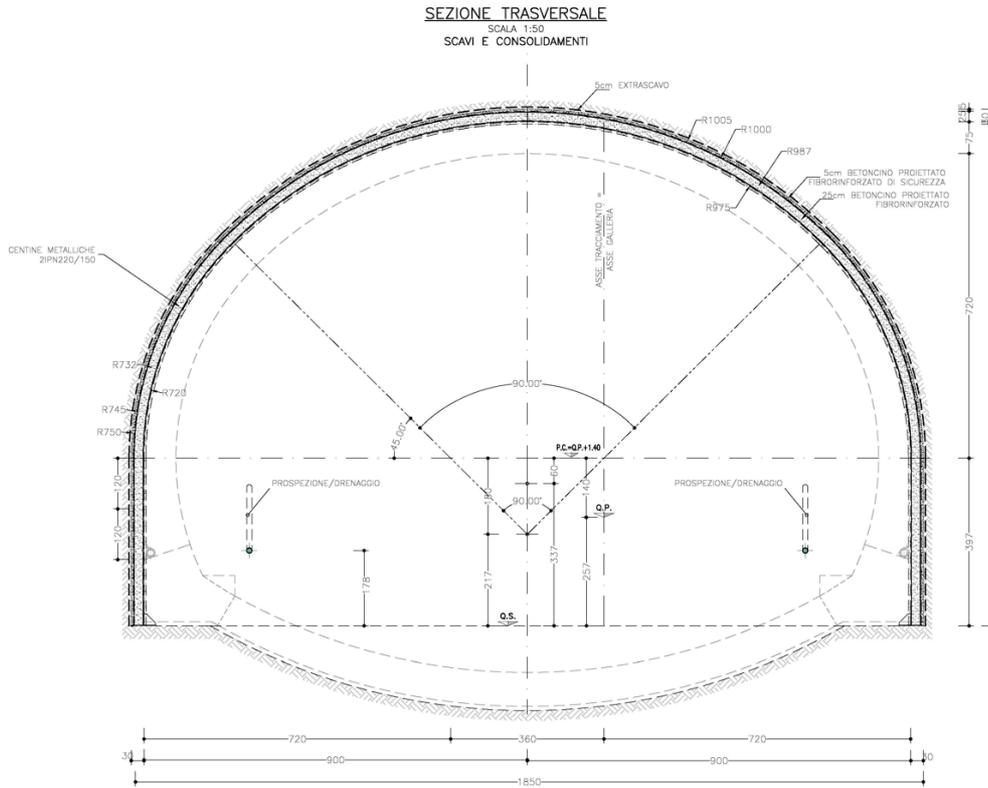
Sezione PS-A2 – Sezione di scavo.
